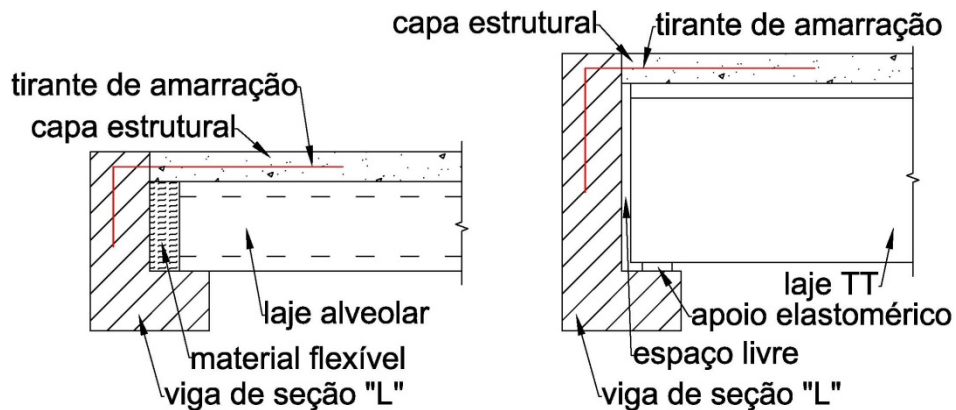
Ligação viga-laje sem restrição à rotação da laje, (a) laje alveolar, (b) laje TT [adaptado de FIB (2008)].
